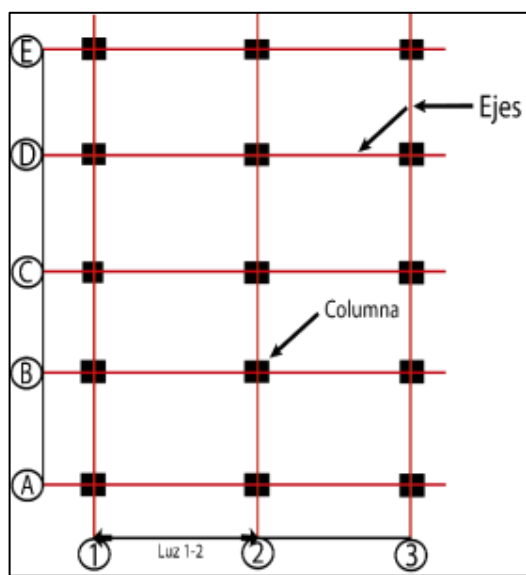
Plano estructural de edificio a diseñar; Fuente: [Grupo investigador]
